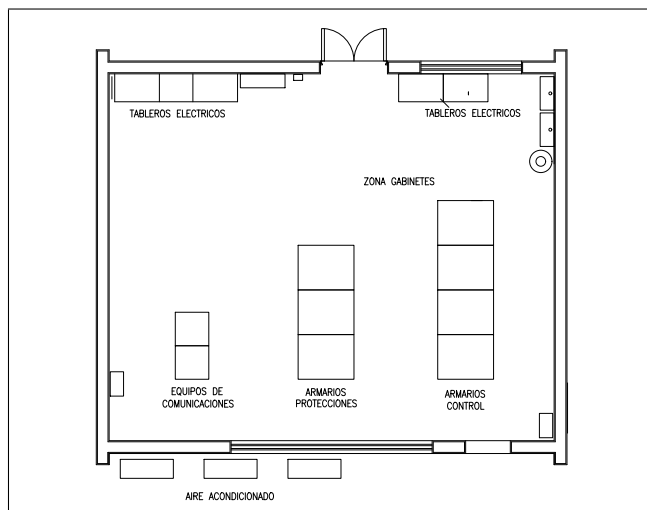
Plano vista en planta de una Caseta de Control de Diagonal.
